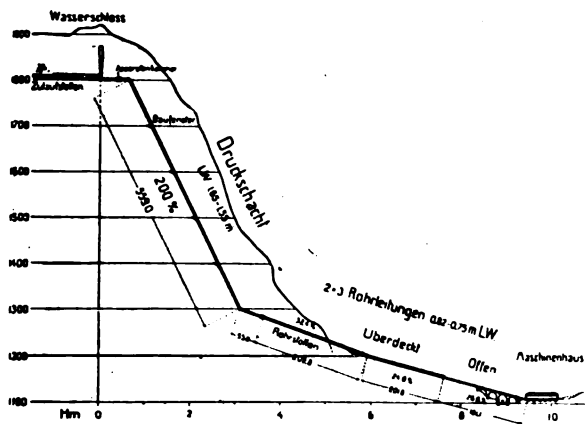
Profil en long de la centrale de Guttannen et des conduites forcées.
